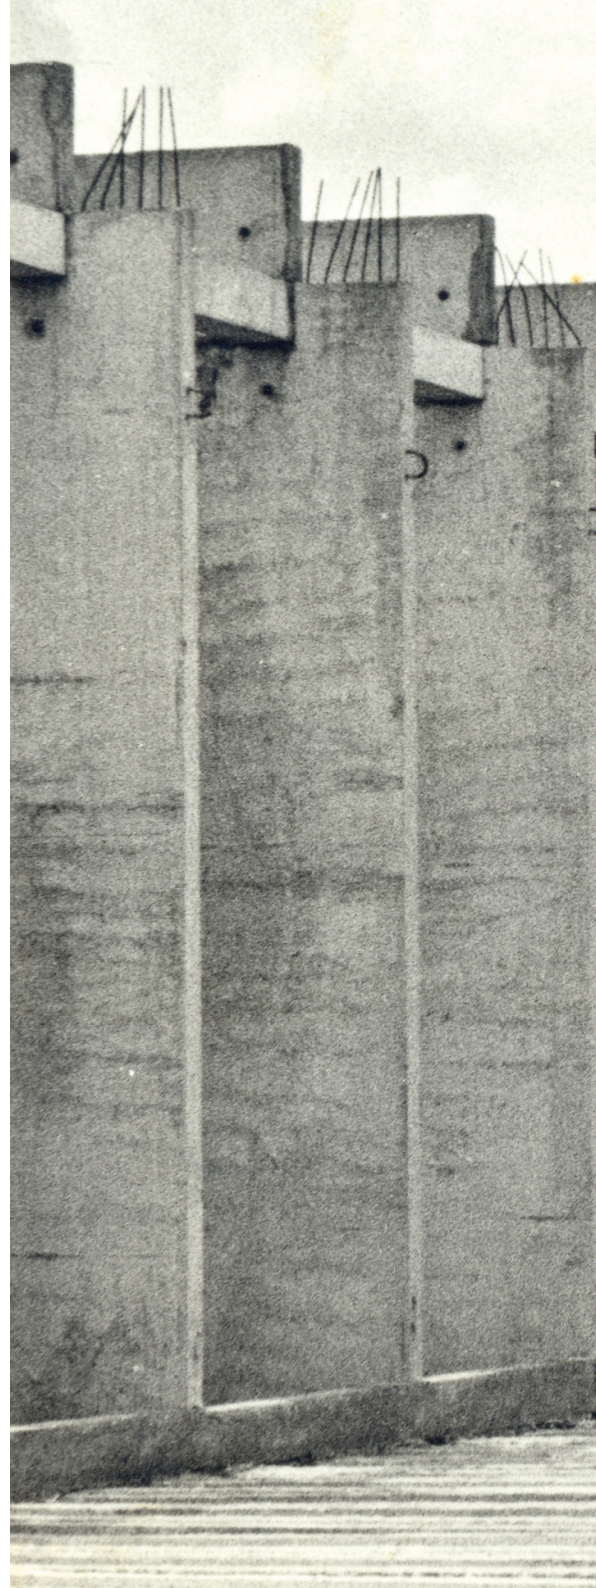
Detalhe das vigas calhas da cobertura, ICC.
